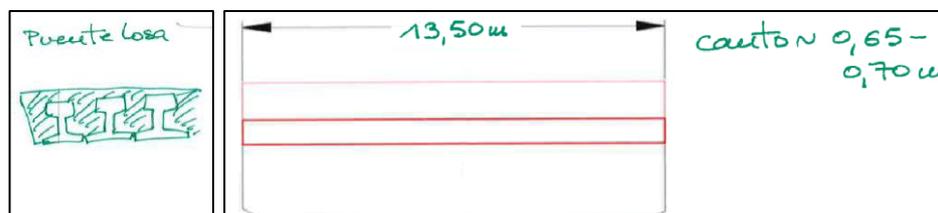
Esquema con tipología de puente para calle Leonardo Rucabado.
